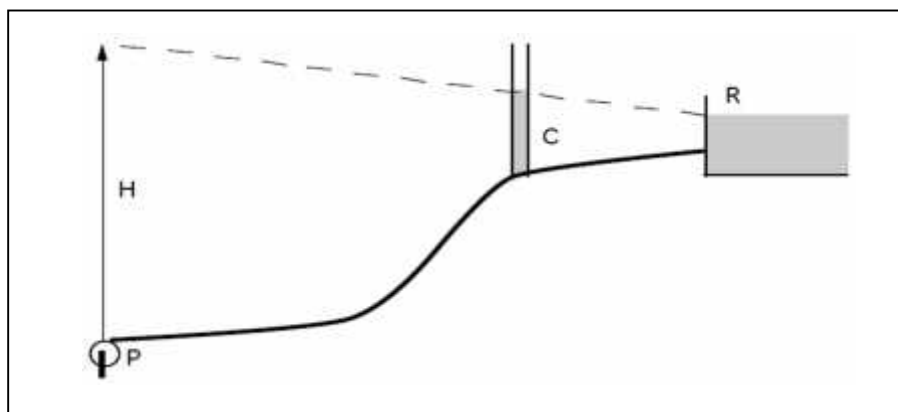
Cheminée d'équilibre sur une conduite de refoulement
